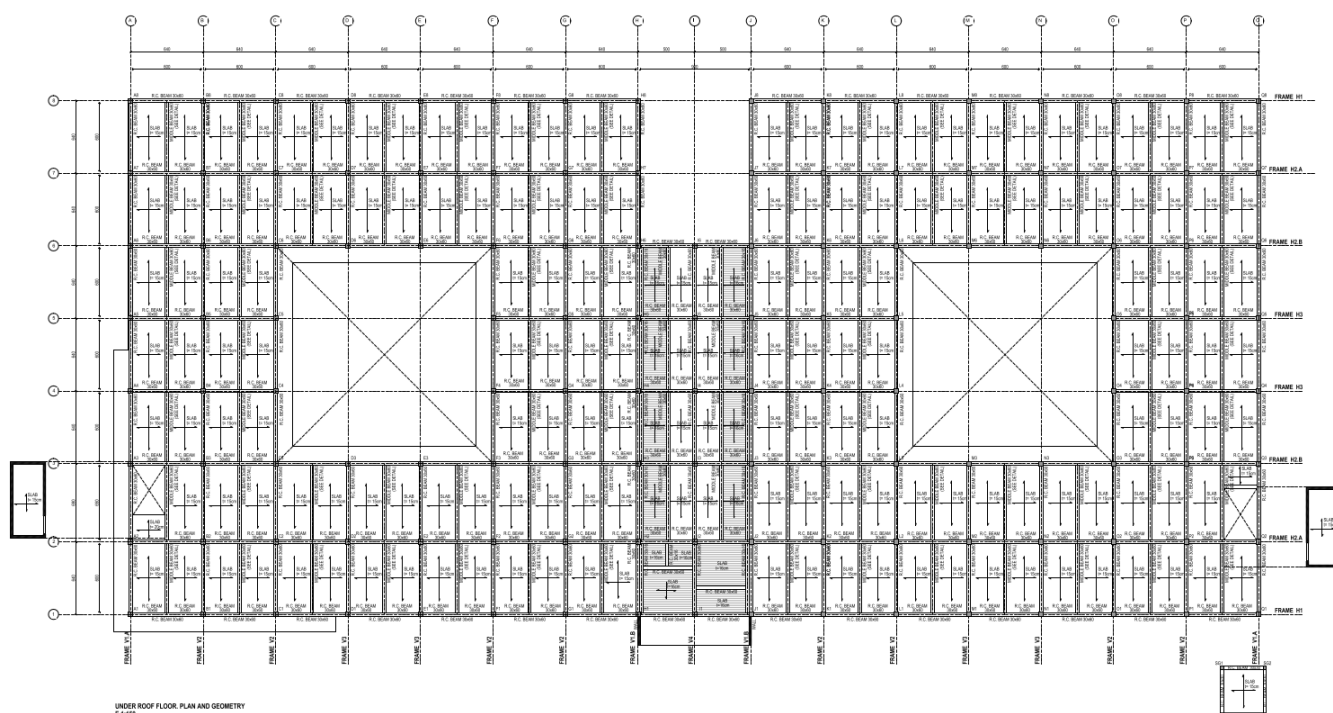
Planta “Food and Drug Quality Control Laboratory”
